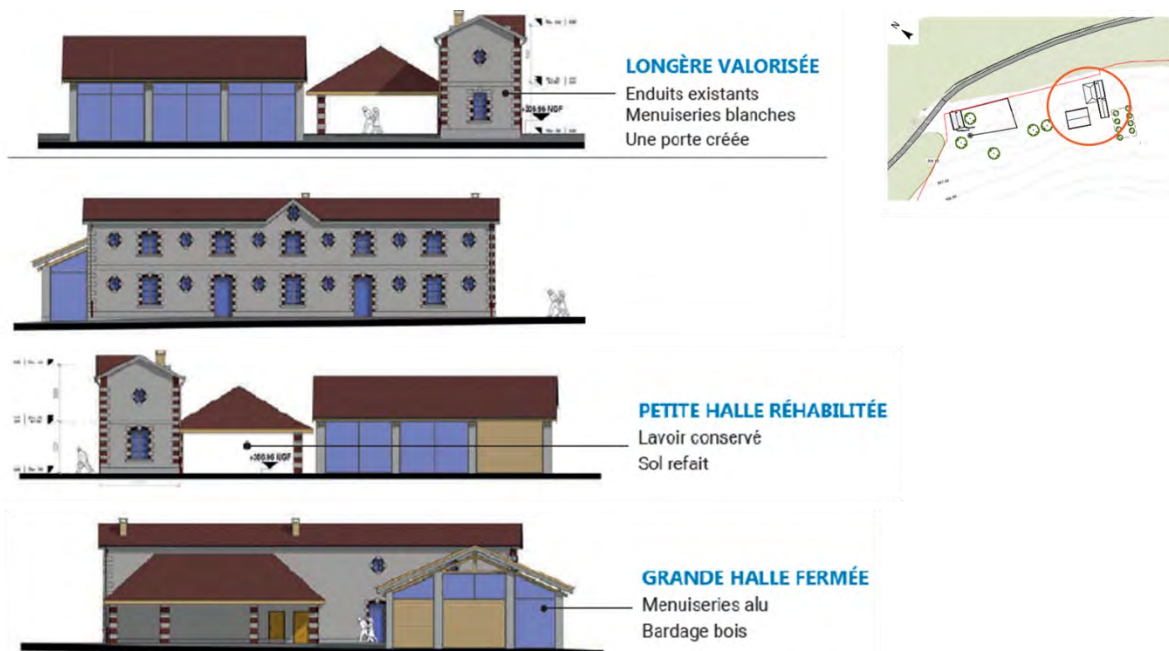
Plans des halles et de la longère (source : Espace Gaïa)
